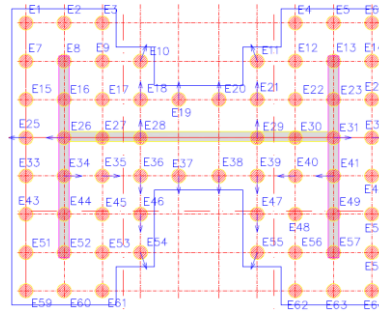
Blocco di fondazione delle pareti di irrigidimento
